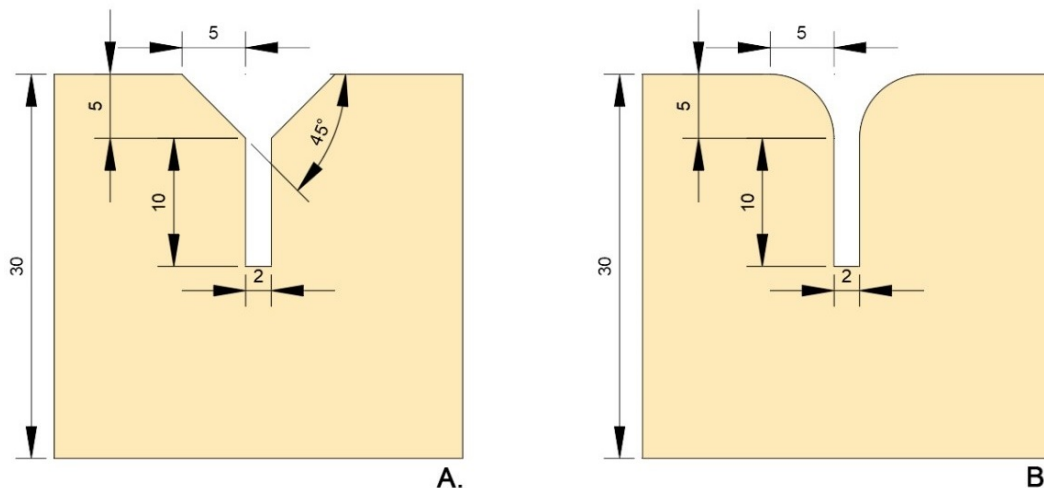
Deux variantes de l'assemblage à mi-bois (dimensions en cm)
